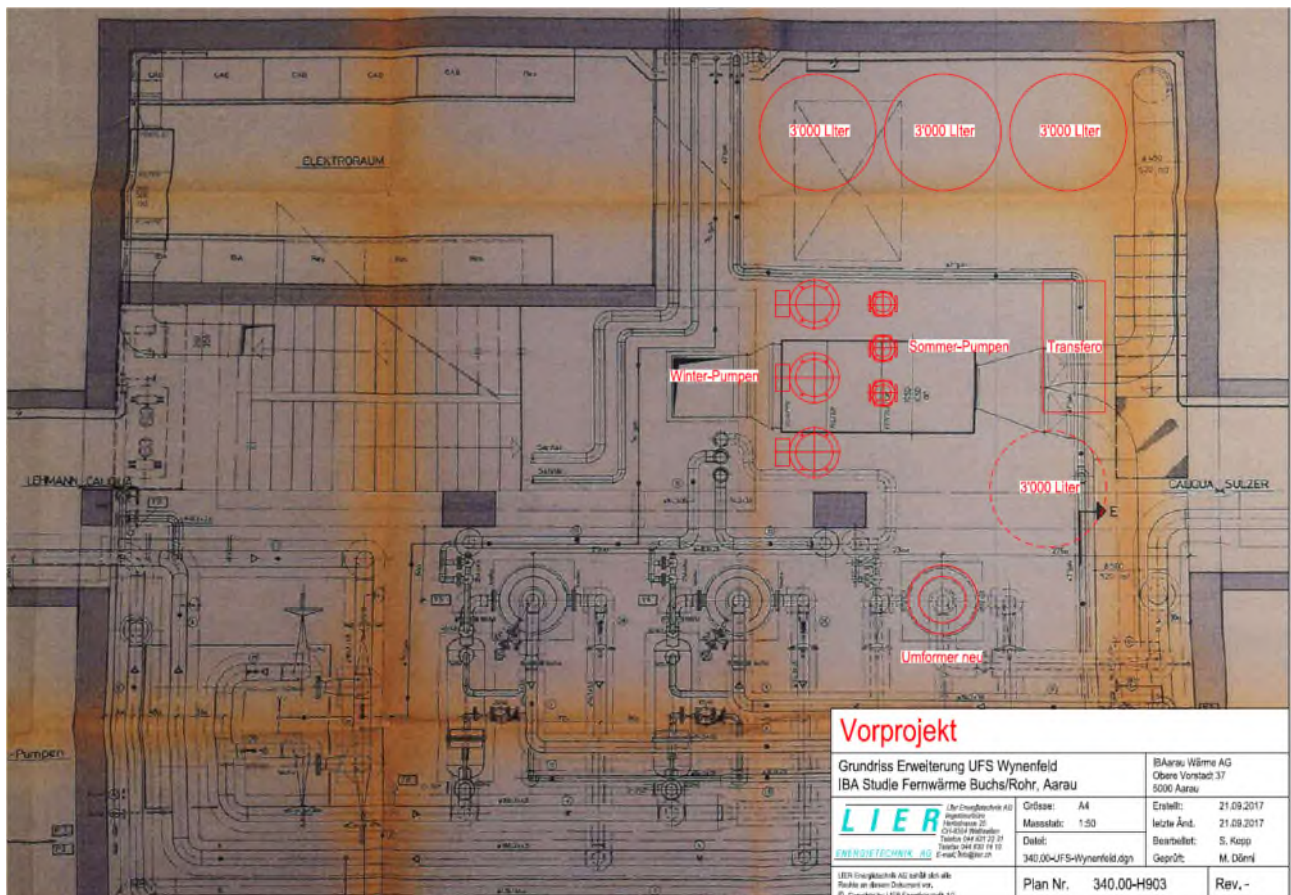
Grundriss UFW mit Ausbau 3. Dampfumformer und FW-Station Buchs / Aarau-Rohr
